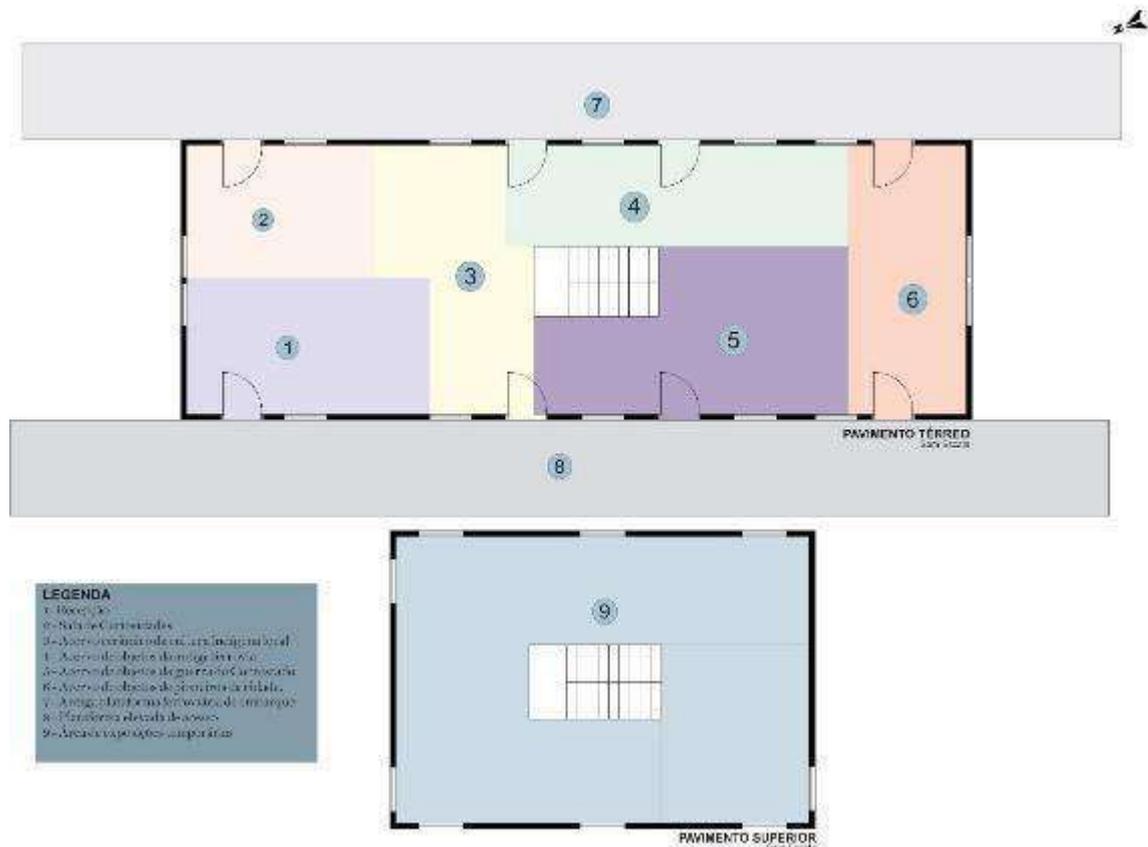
Configuração interna da antiga estação ferroviária Rio Caçador, fonte: as autoras (2020).
